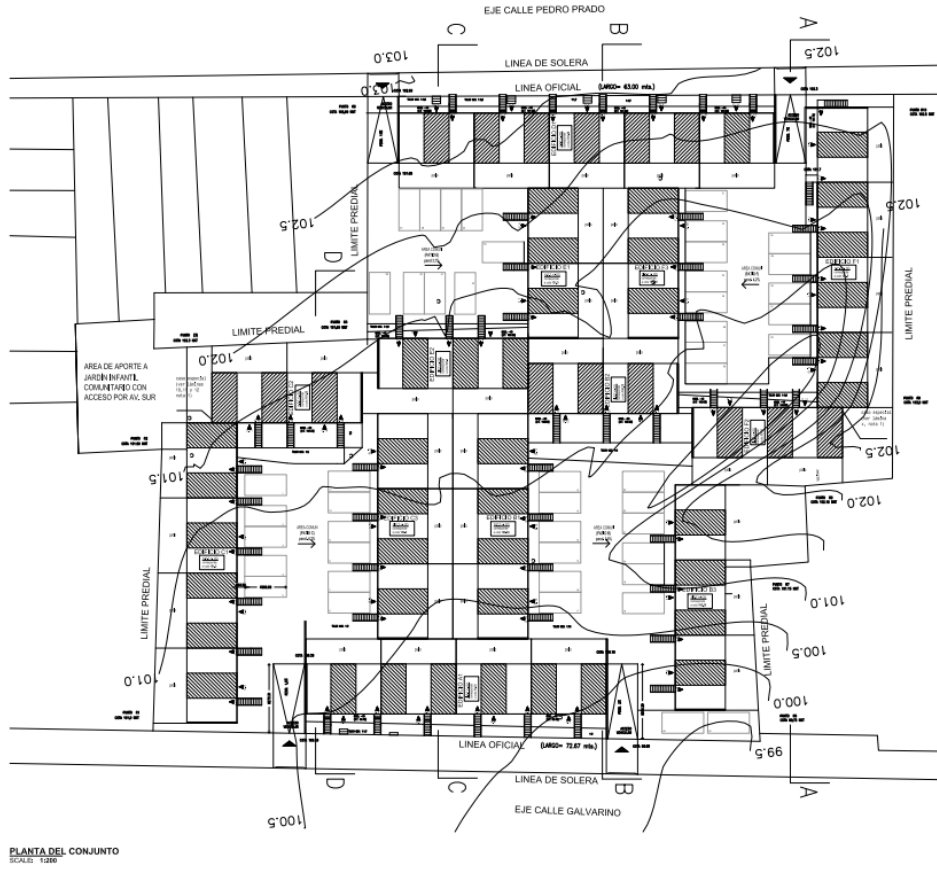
Implantação. Fonte: Projeto Elemental – Quinta Monroy, 2016.
